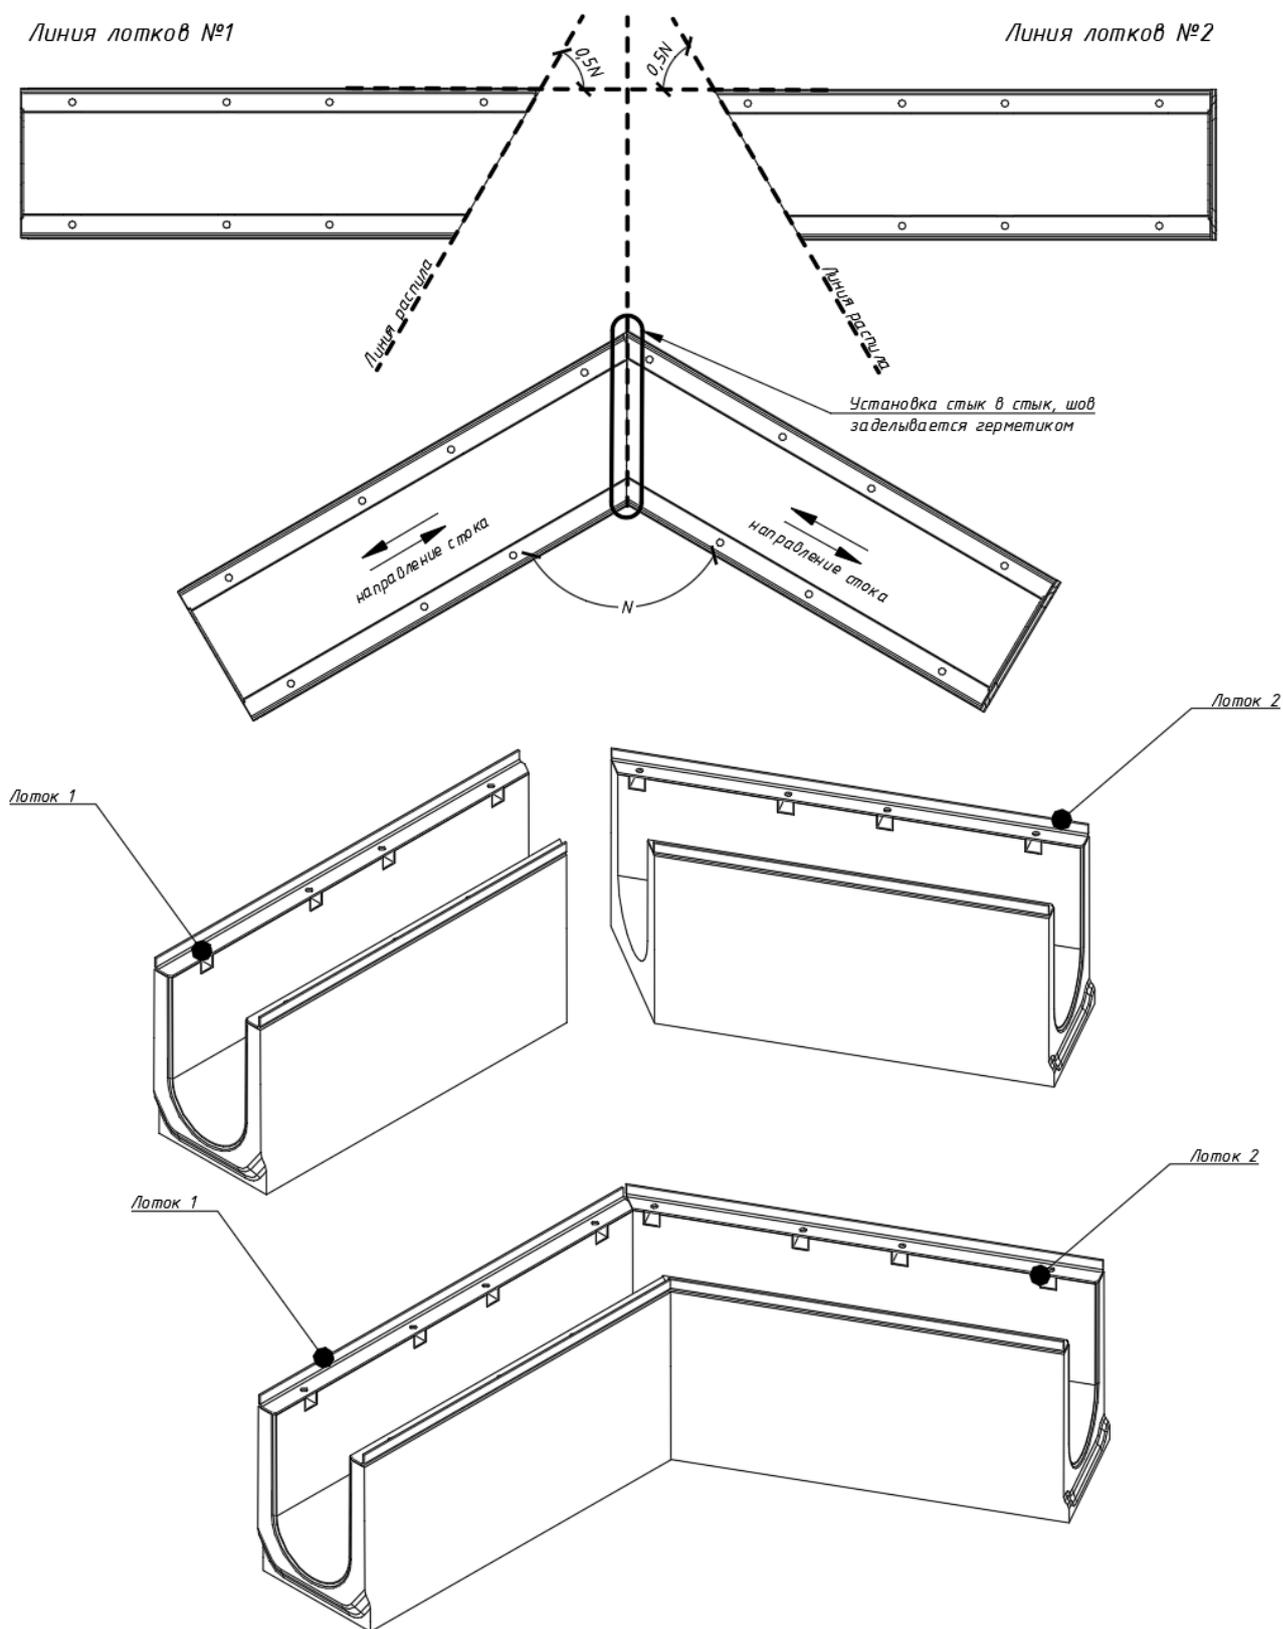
Схема стыковки лотков под произвольным углом.
